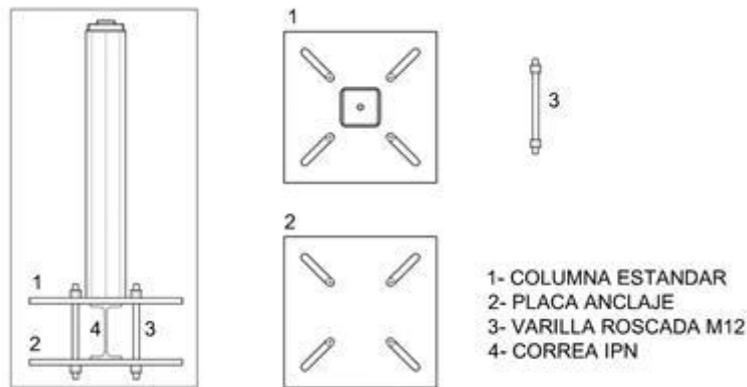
Esquema de montaje del anclaje estructural Travspring.
